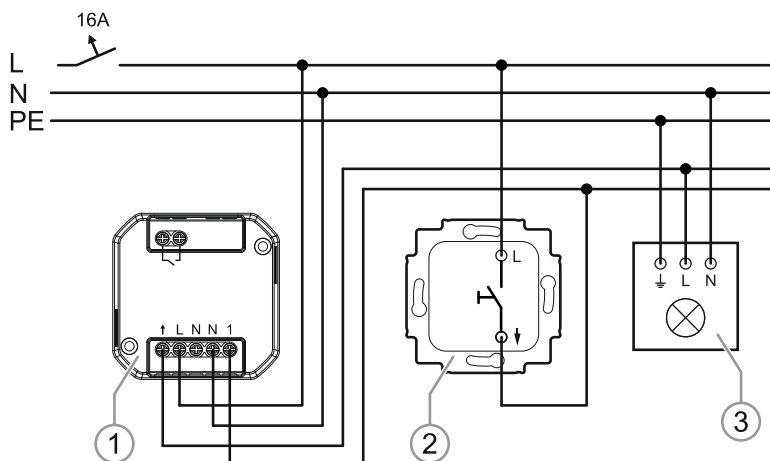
Beispiel-Schaltplan: Einzelbüro-Lichtsteuerung mit Taster für manuellen Modus
